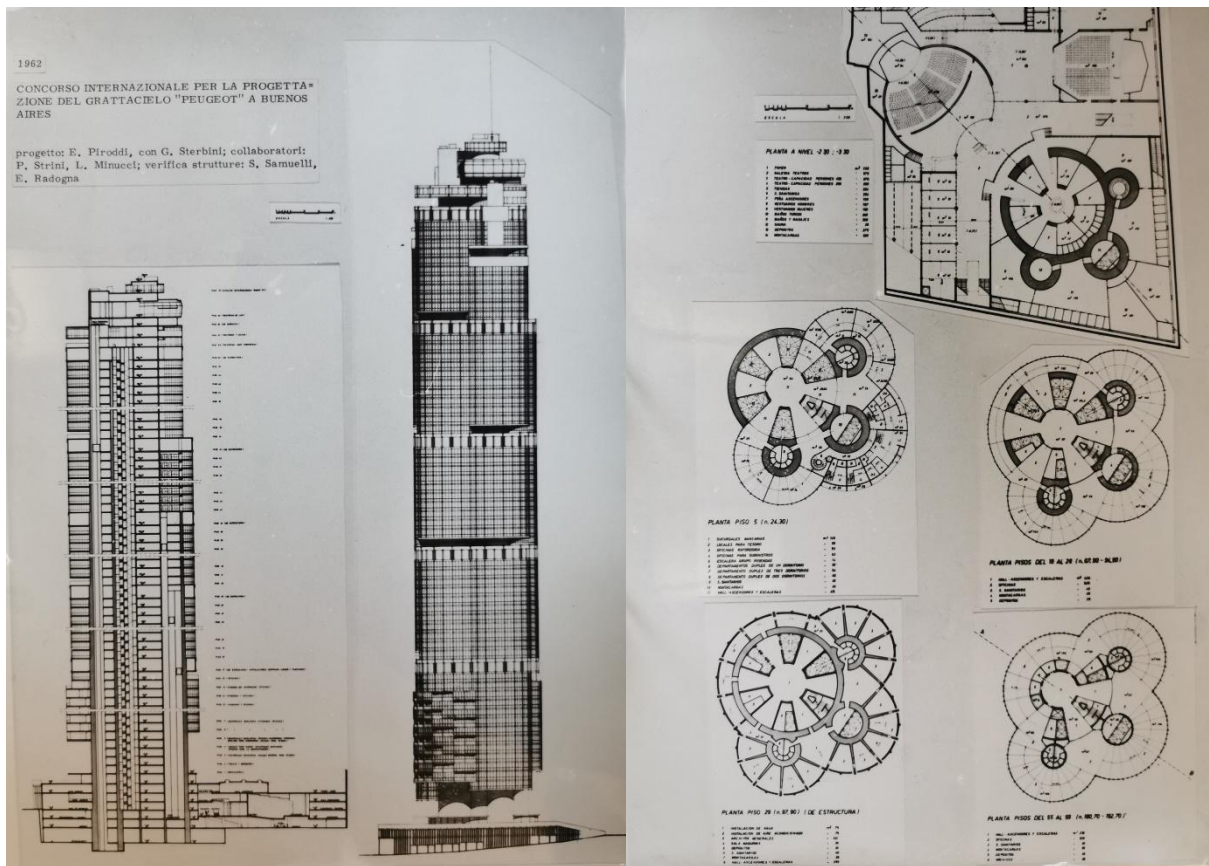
Elio Piroddi y Giulio Sterbini, Proyecto de concurso para el Edificio Peugeot, sección, fachada y planos. Roma, Archivio Centrale dello Stato, Fondo Elio Piroddi, carpeta 2. Con autorización del Ministero della Cultura / Archivio Centrale dello Stato, prot. n. 966/2026.
